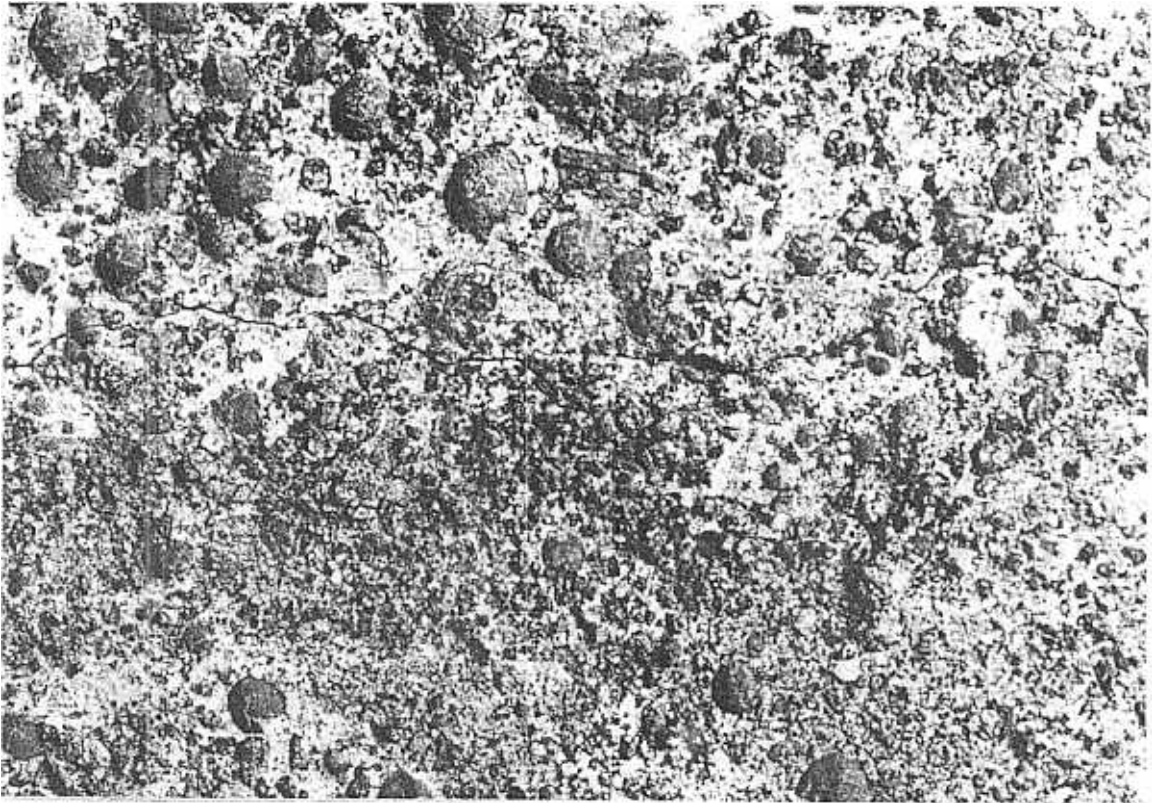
Riß in Konstruktionsleichtbeton über verzinktem Bewehrungsstahl
